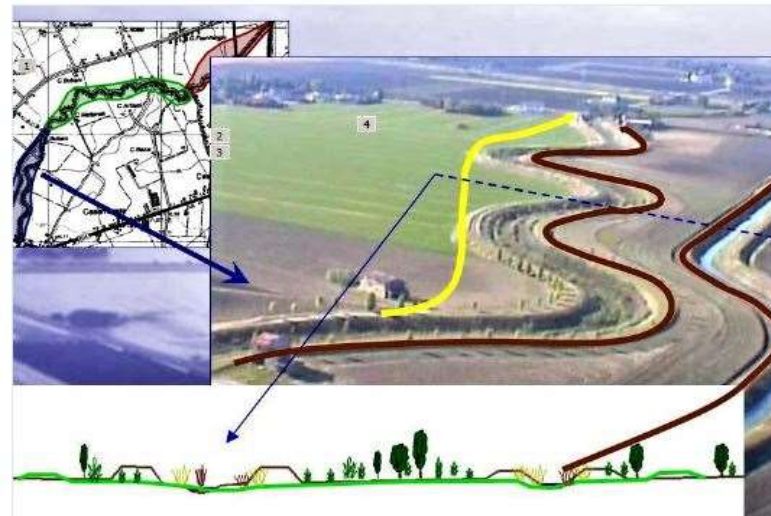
Sezione tipo dell'intervento sul torrente Bevano
